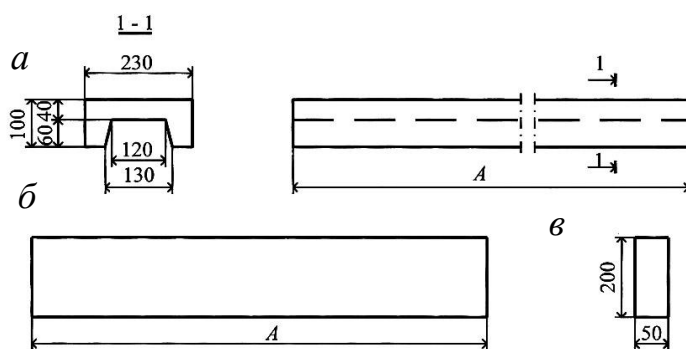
Плита перекрытия (а), лежан (б) лотков канавки, и плита (в), поддерживающая балластный слой
